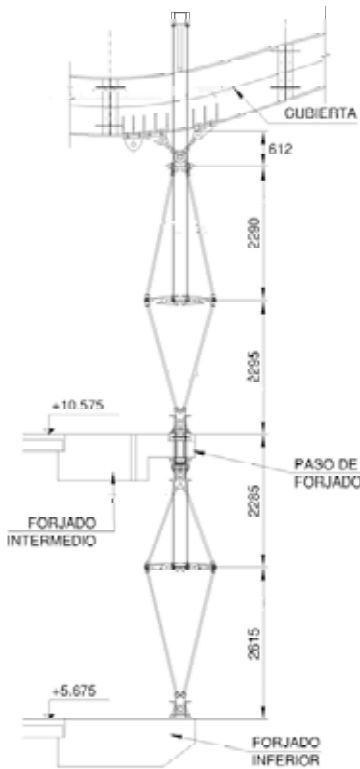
Muro cortina tipo A-5. Sección Tipo.
